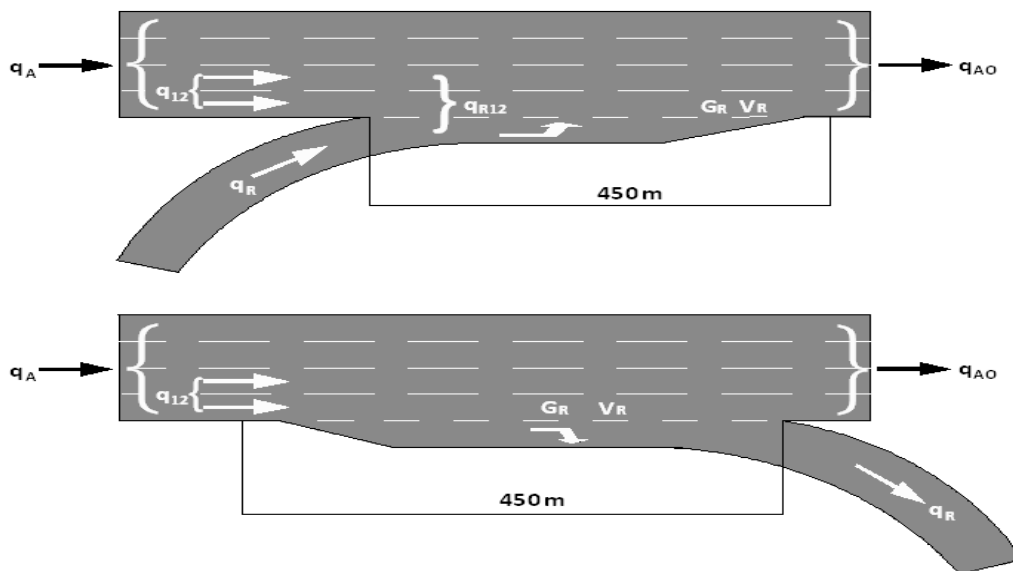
Ndryshoret kryesore në zonën e ndikimit të rampave
